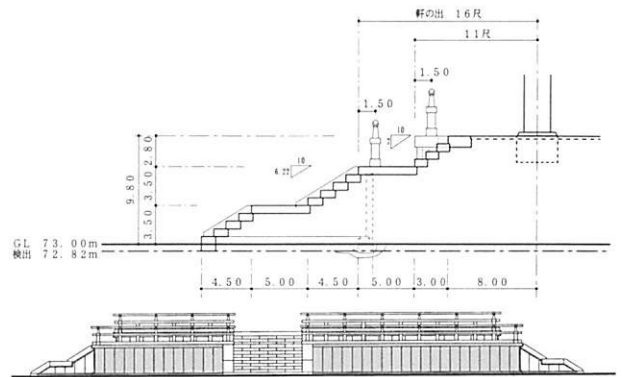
案① 階段部分断面図(1:200)・東立面図(1:500)
